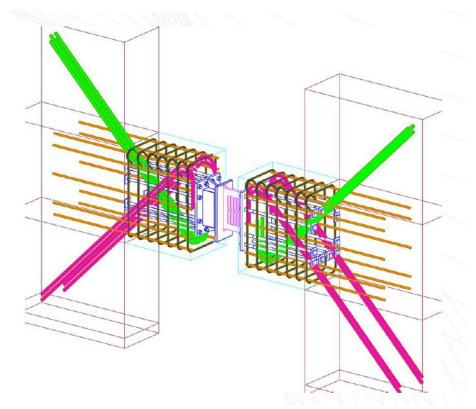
Vigas cortas entre muros y disipador en la mitad de vigas de acople
